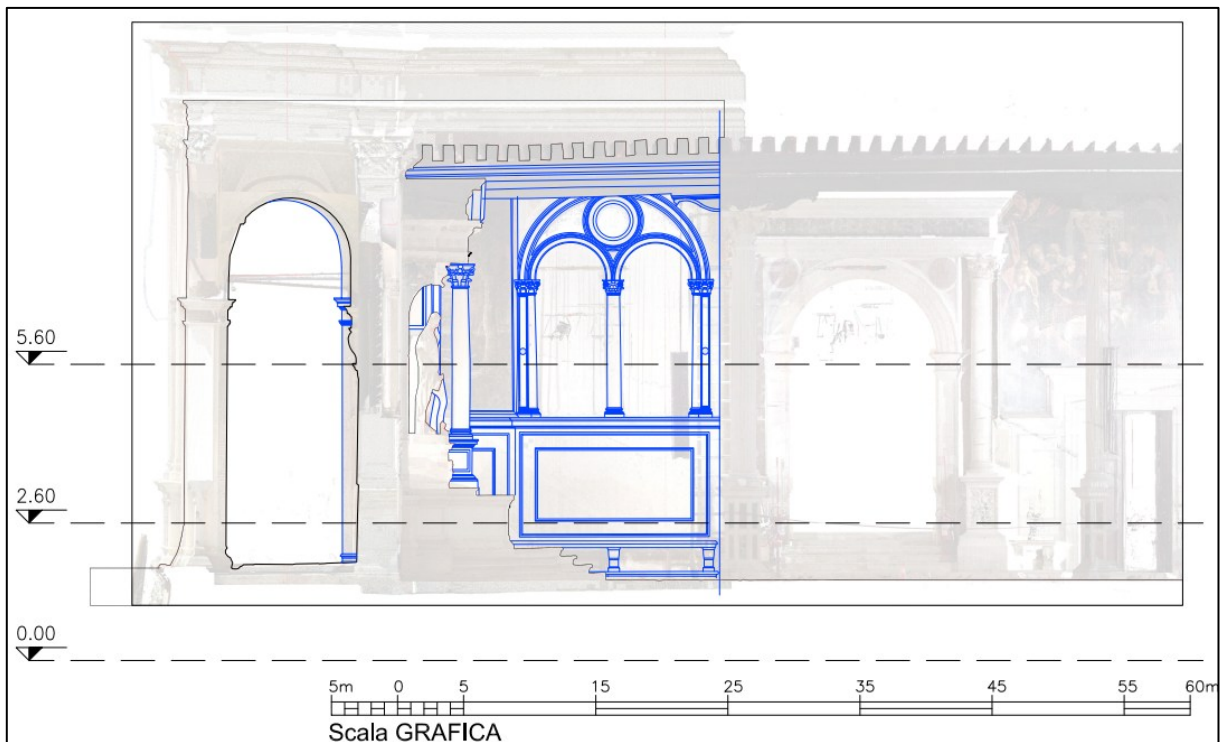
Sezione 5 – Sezione verticale con sovrapposizione dell'orto-proiezione del modello tridimensionale
